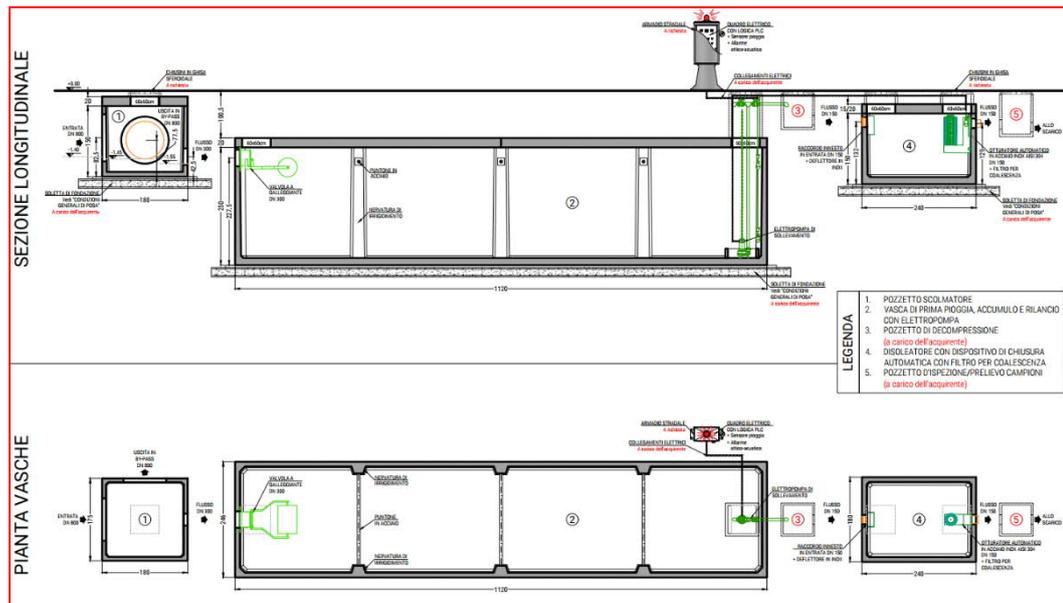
SEZIONE LONGITUDINALE E PIANTA DELL'IMPIANTO DI PRIMA PIOGGIA CON DISOLEATORE E POZZETTO CARBONI ATTIVI
